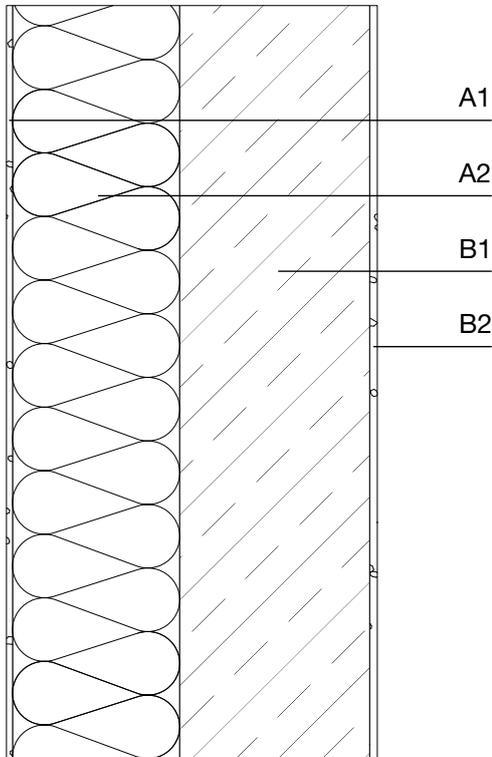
Horizontalschnitt Wandaufbau WA4, M 1:10
